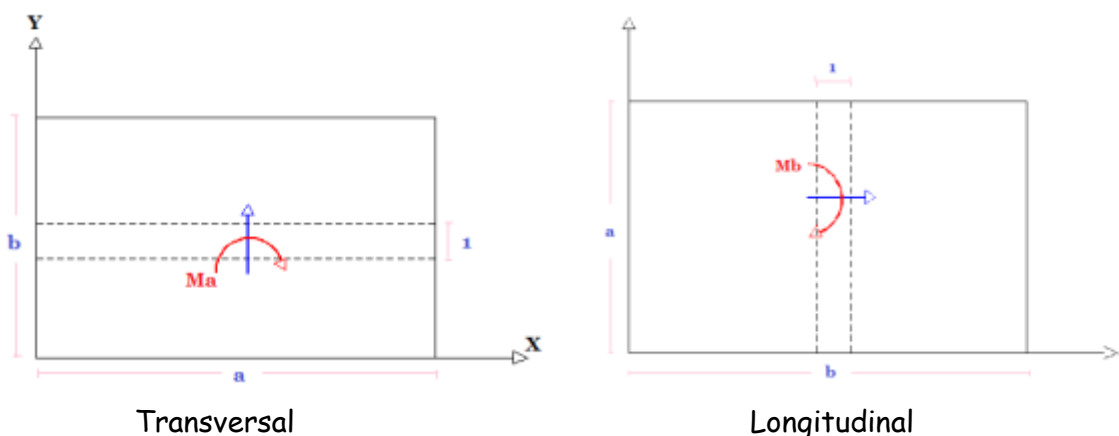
Moments Transversal et Longitudinal sur la dalle centrale.
